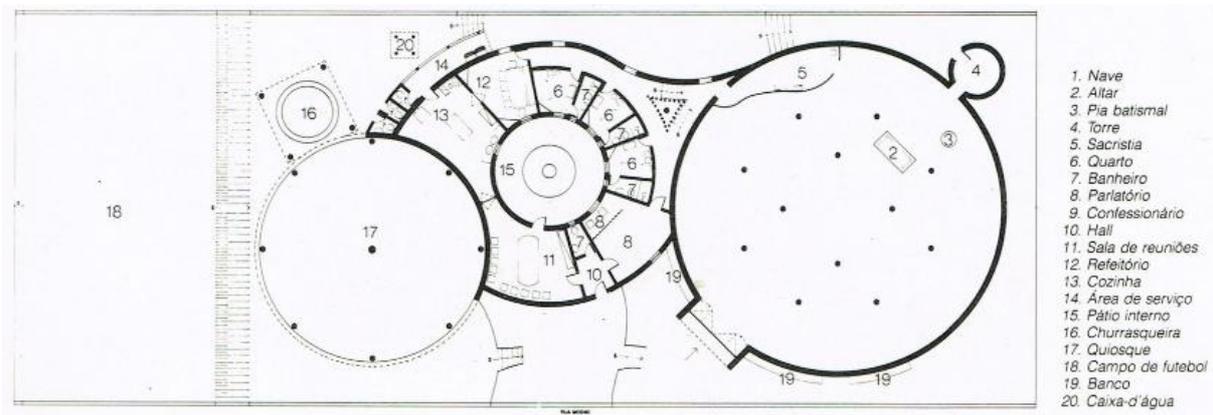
Planta baixa do conjunto arquitetônico. Fonte: Revista Projeto, p. 59.
